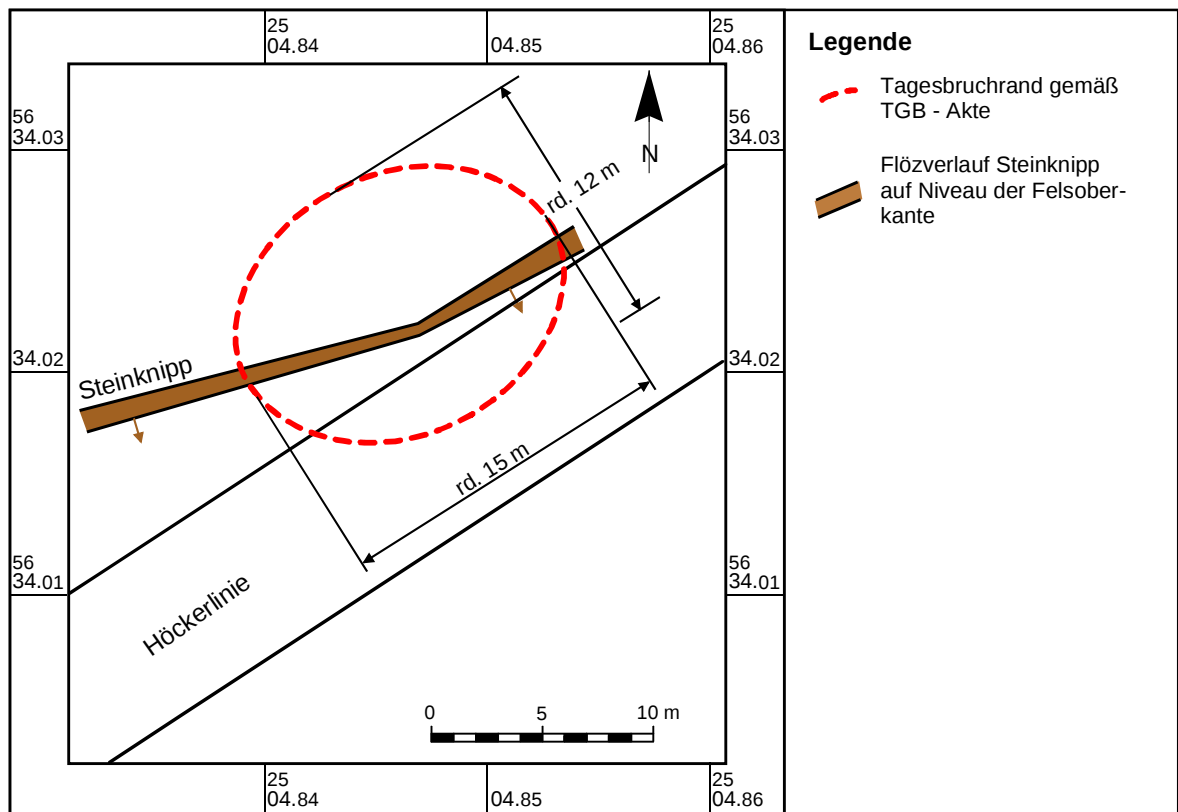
Lageplan Tagesbruch Mühlenbach, Herzogenrath
